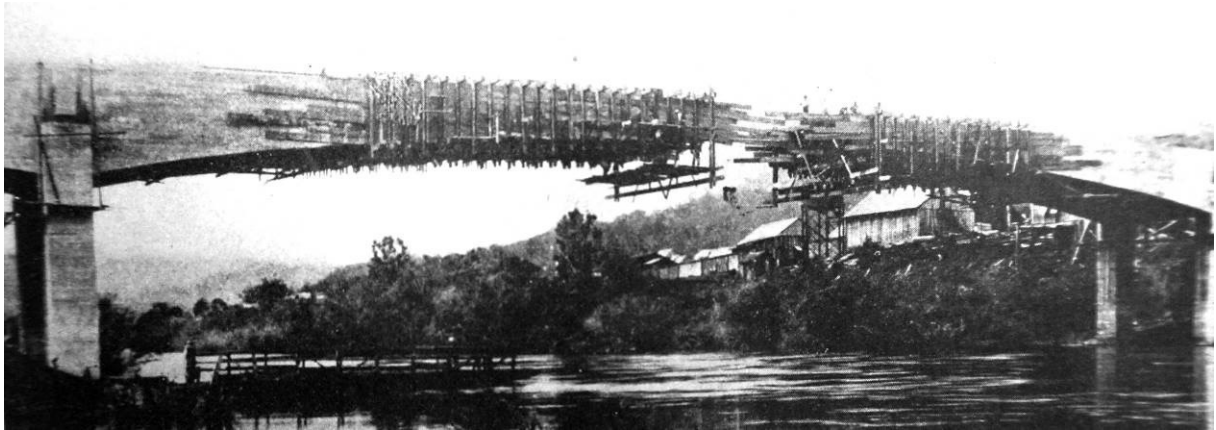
Foto da ponte em construção. Execução do sistema de Cantilever. FONTE: SCHJÖDT, 1930.
